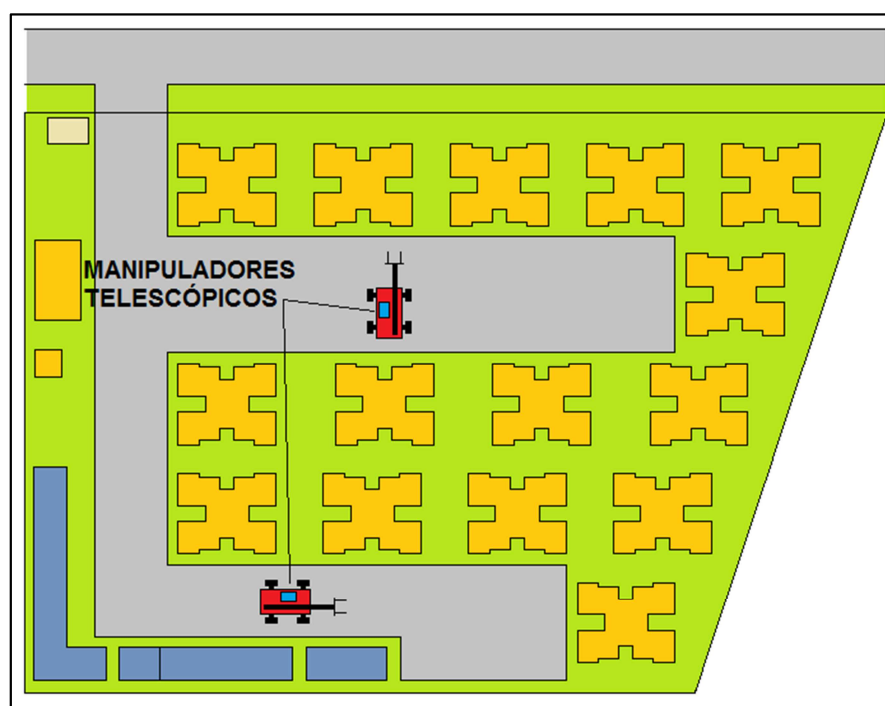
Manipuladores telescópicos no canteiro de obra.
